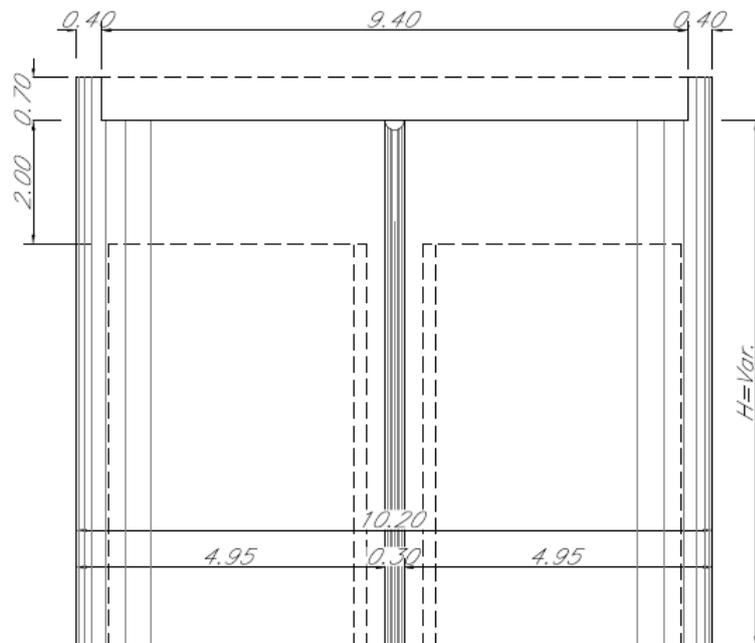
Prospetto trasversale pila - Bicellulare doppio binario 10.20m x 3.60m
